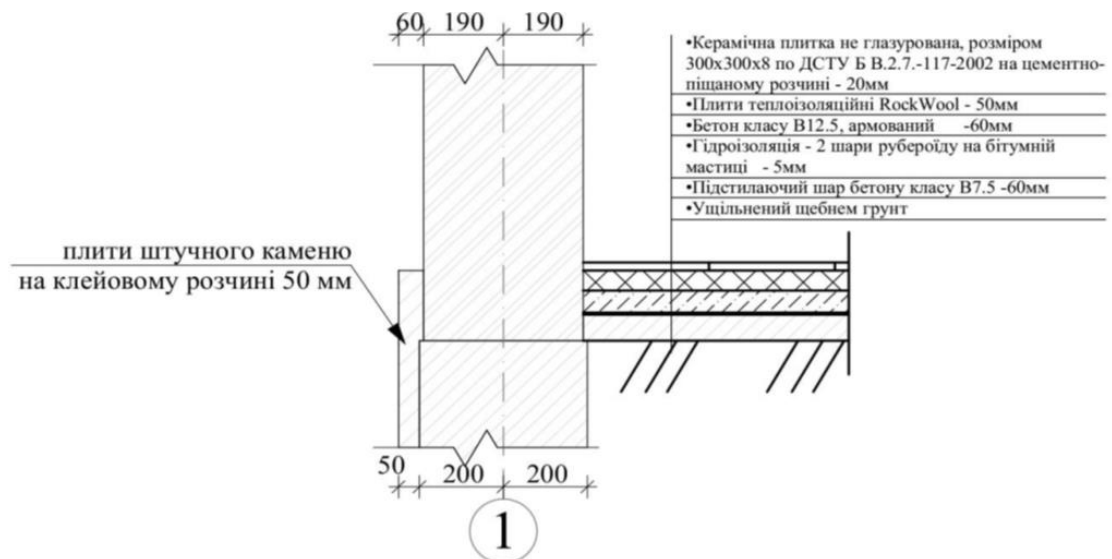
Схема примикання переkritтя першого поверху до конструкції стіни.
